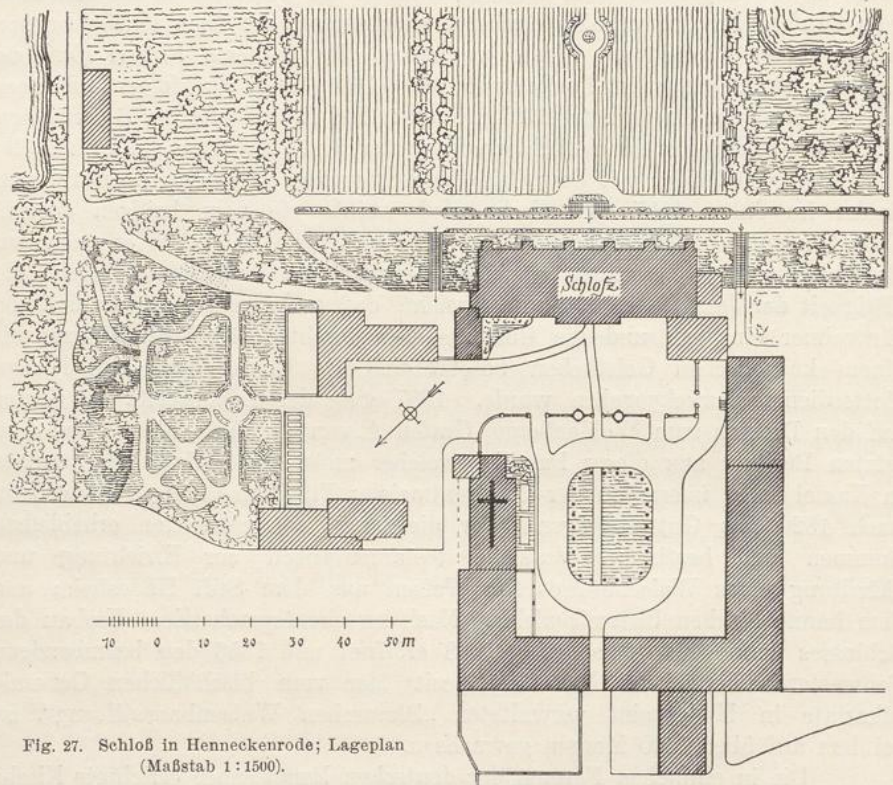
Schloß in Henneckenrode; Lageplan (Maßstab 1:1500).
